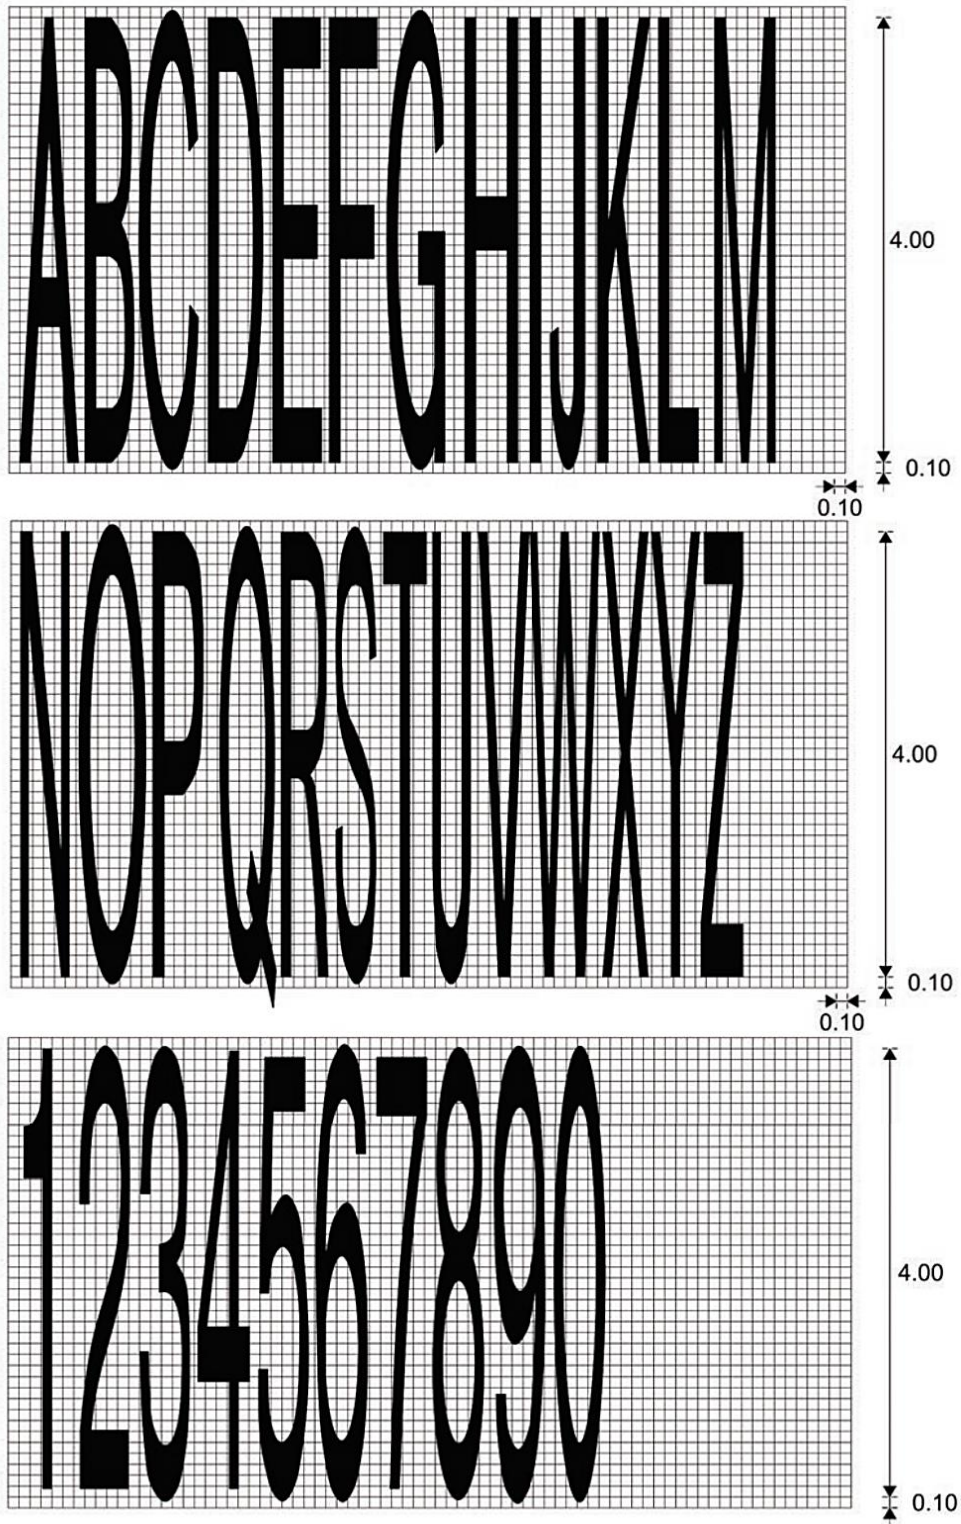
Letras para marcas sobre el pavimento en carreteras de hasta 60 km/h
